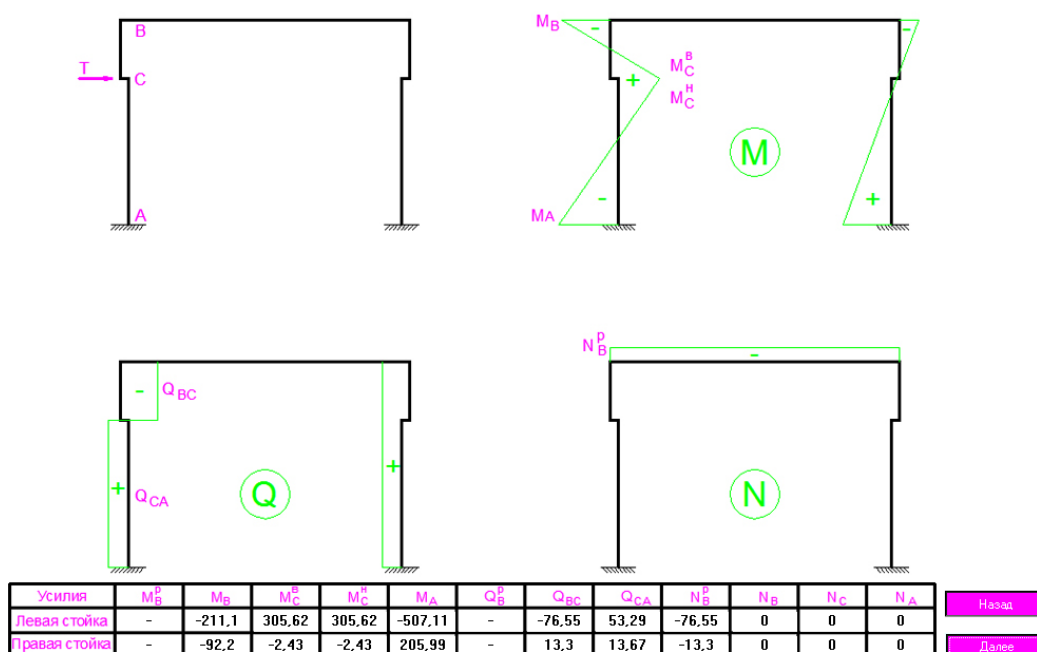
Эпюры усилий от горизонтальной крановой нагрузки
